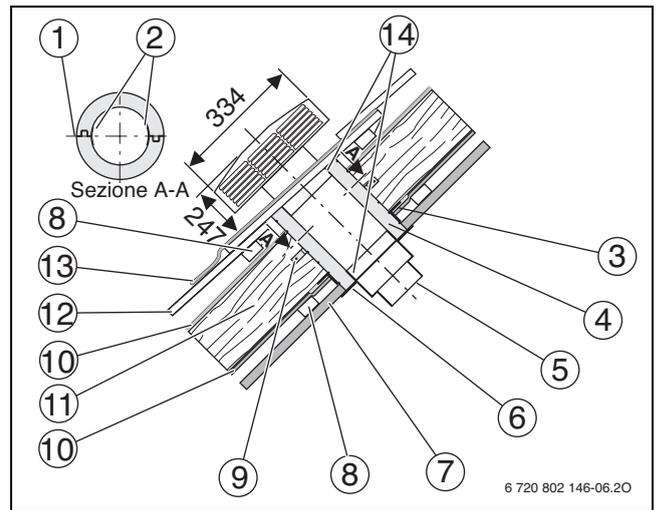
Vista in sezione del montaggio della bocchetta a tetto DDF 160/1 (quote in mm)
